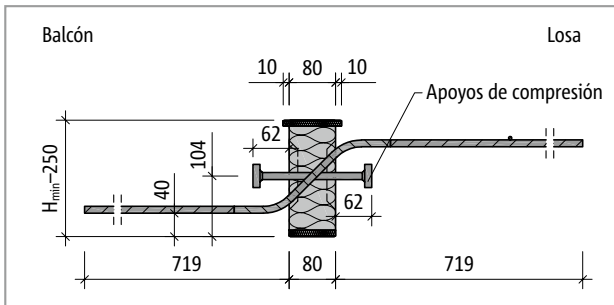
Schöck Isokorb® T tipo Q-P-V7: Sección del producto
